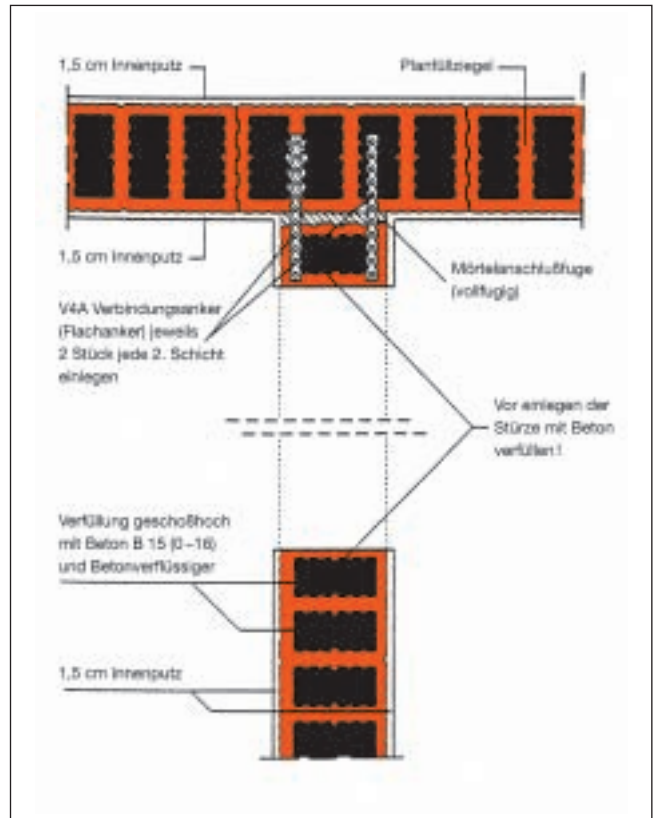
Horizontalschnitt aus geschosshohen Plan-Füllziegeln
